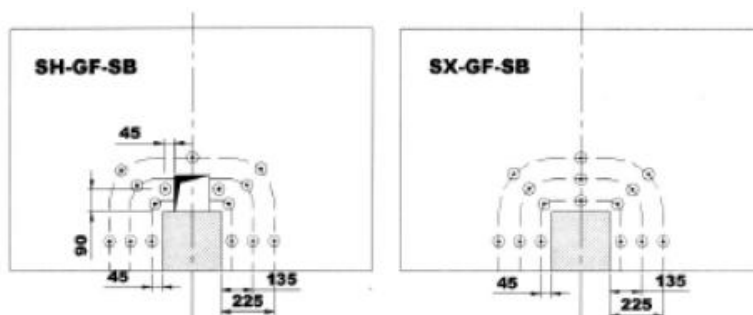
Disposição em planta dos parafusos utilizados no reforço das lajes (com e sem abertura) [9]
